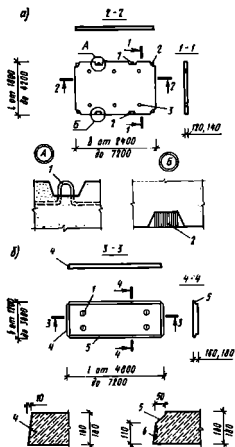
Плиты железобетонные сплошные для перекрытий жилых и общественных зданий:
